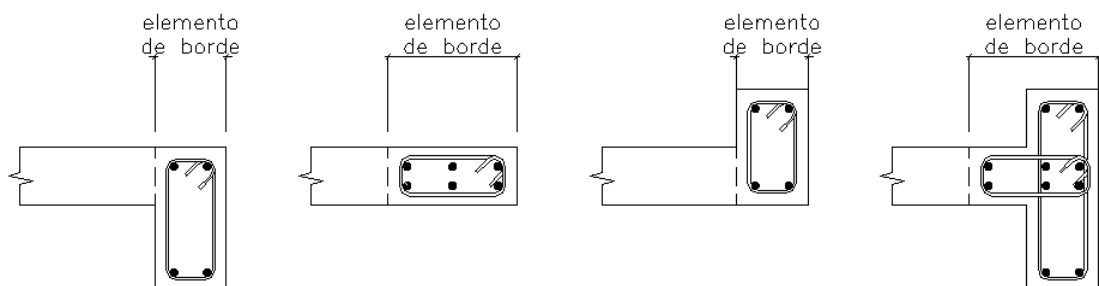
Ejemplos de elementos de borde en diafragmas estructurales
